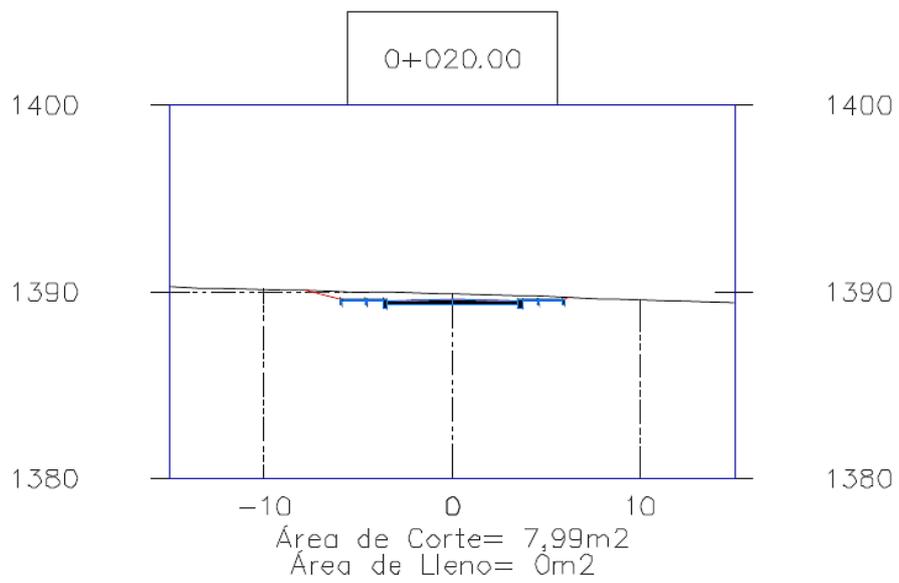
Sección Transversal, abscisa 0+020. Elaboración Propia
